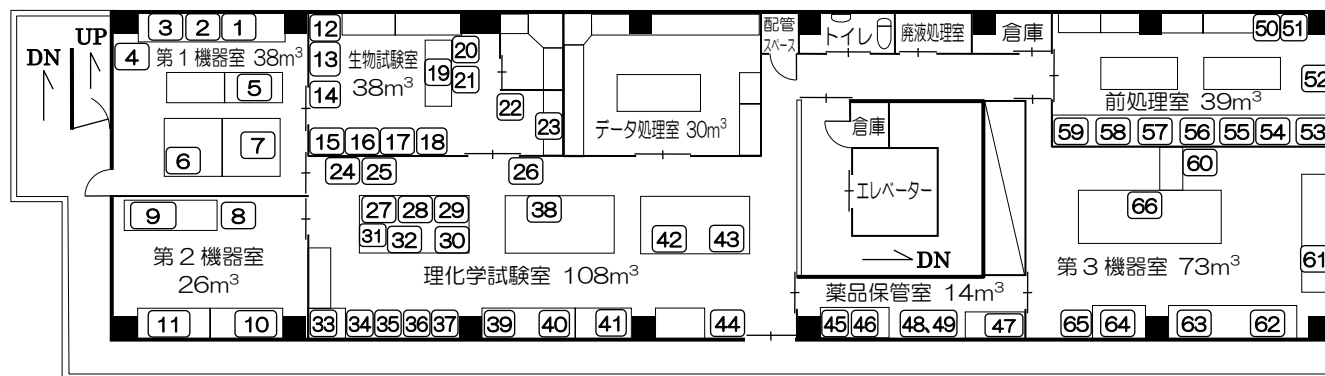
水質試験室平面図及び主要機器配置図 (令和3年(2021年)3月31日現在)
